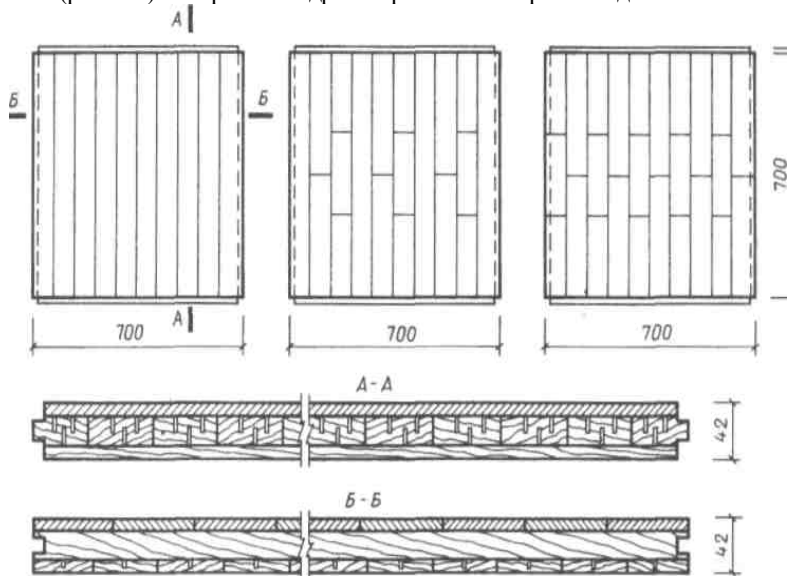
Паркетные щиты – возможные конструкции и размеры
